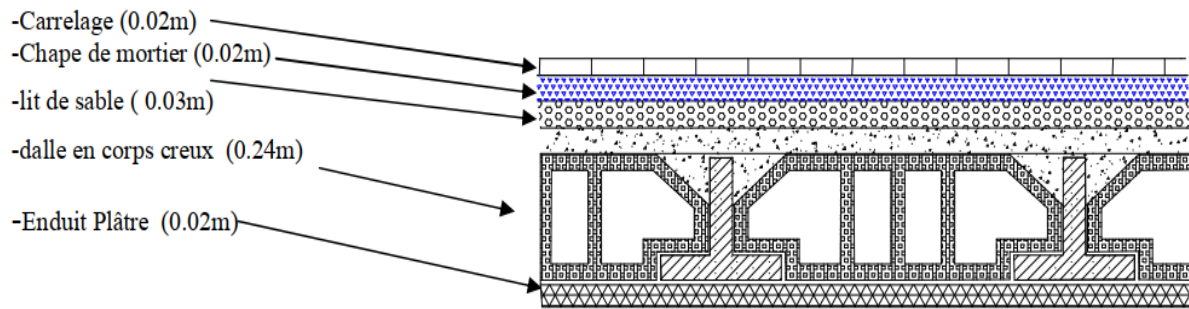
Schéma d'un plancher étage courant
